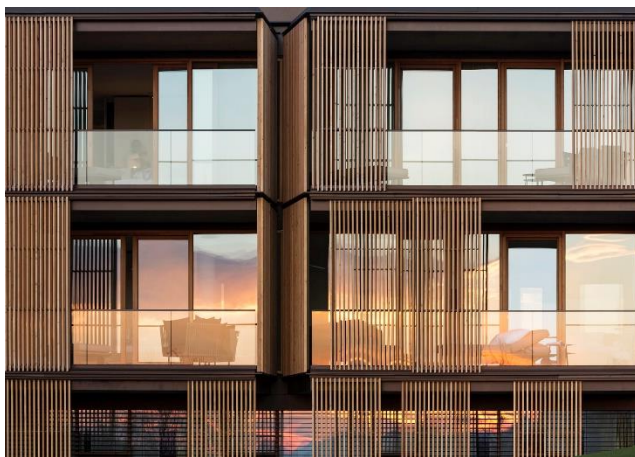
Фасадне рішення будівлі «Lanserhof Tegernsee»[14]
